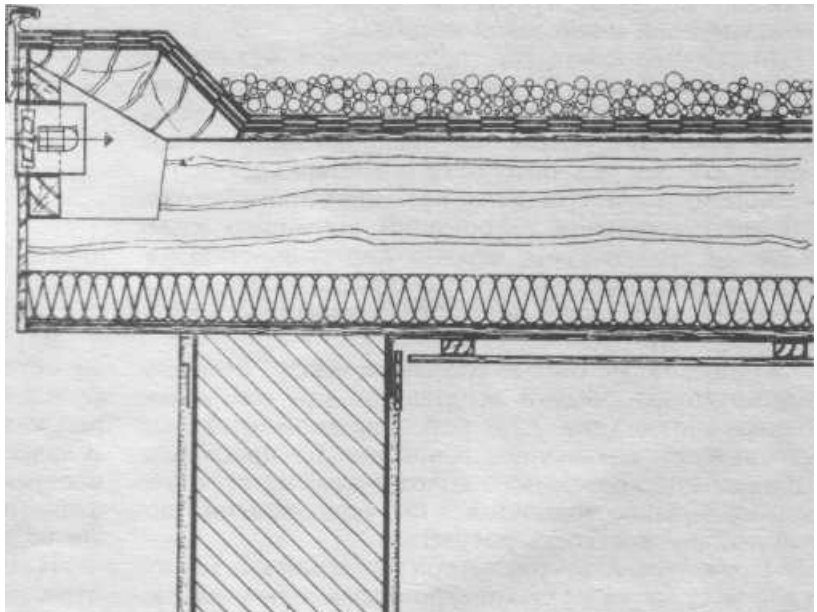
Двухслойная плоская теплая кровли с принудительным вентилированием. Паронепроницаемый слой с внутренней стороны уложен на сплошной несущей плите и связан со стеной
